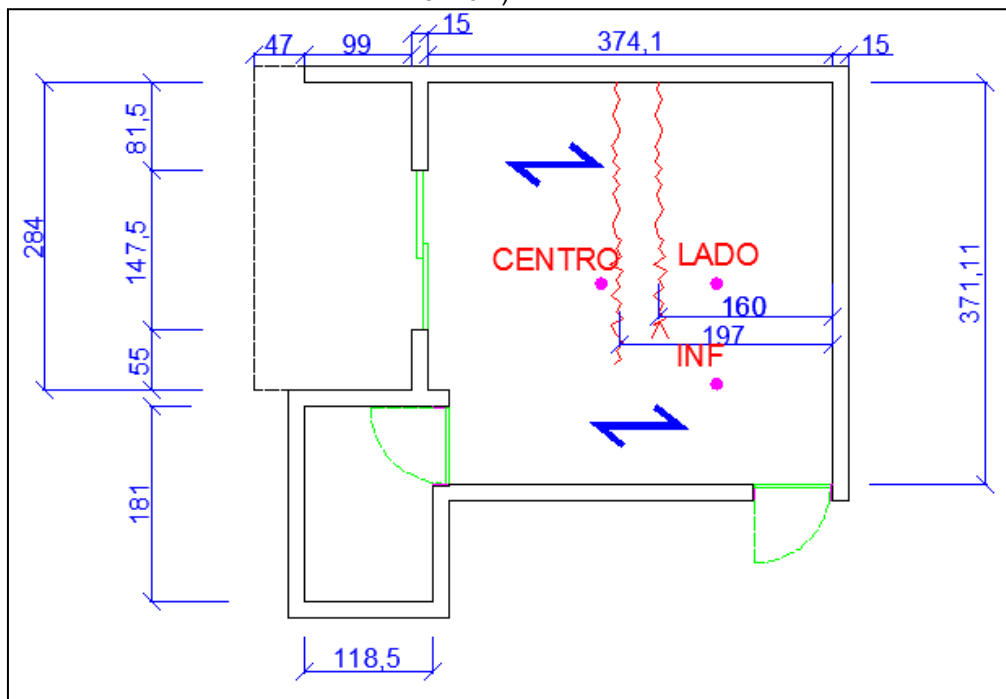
croqui da casa 2A com representação das fissuras e pontos de ensaio (dimensões em cm)
